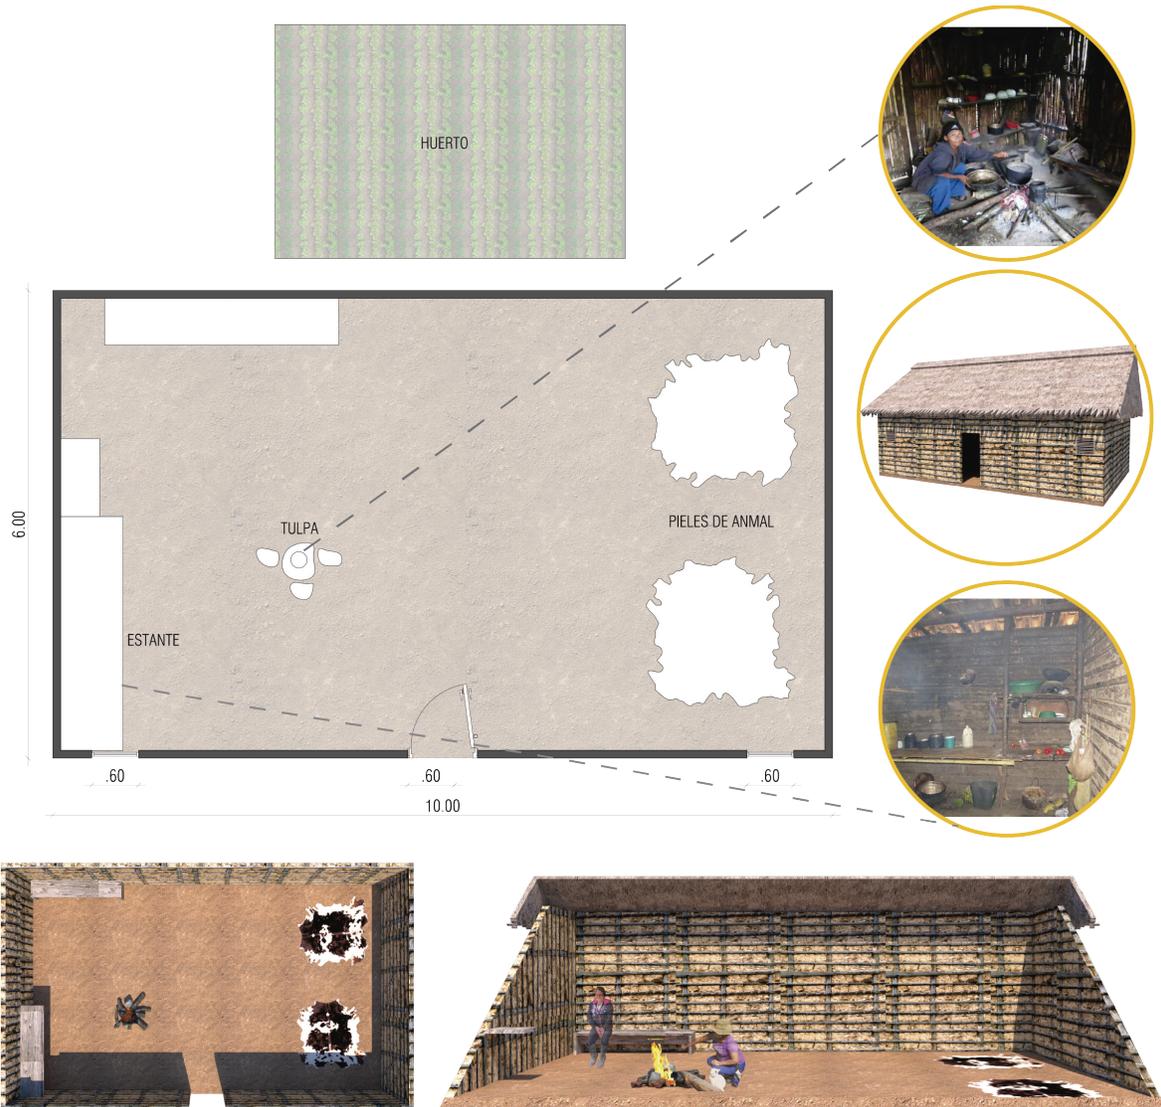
Planta vivienda Nasa tradicional de los años ochenta, juto a un levantamiento 3D de la fachada y el interior.
